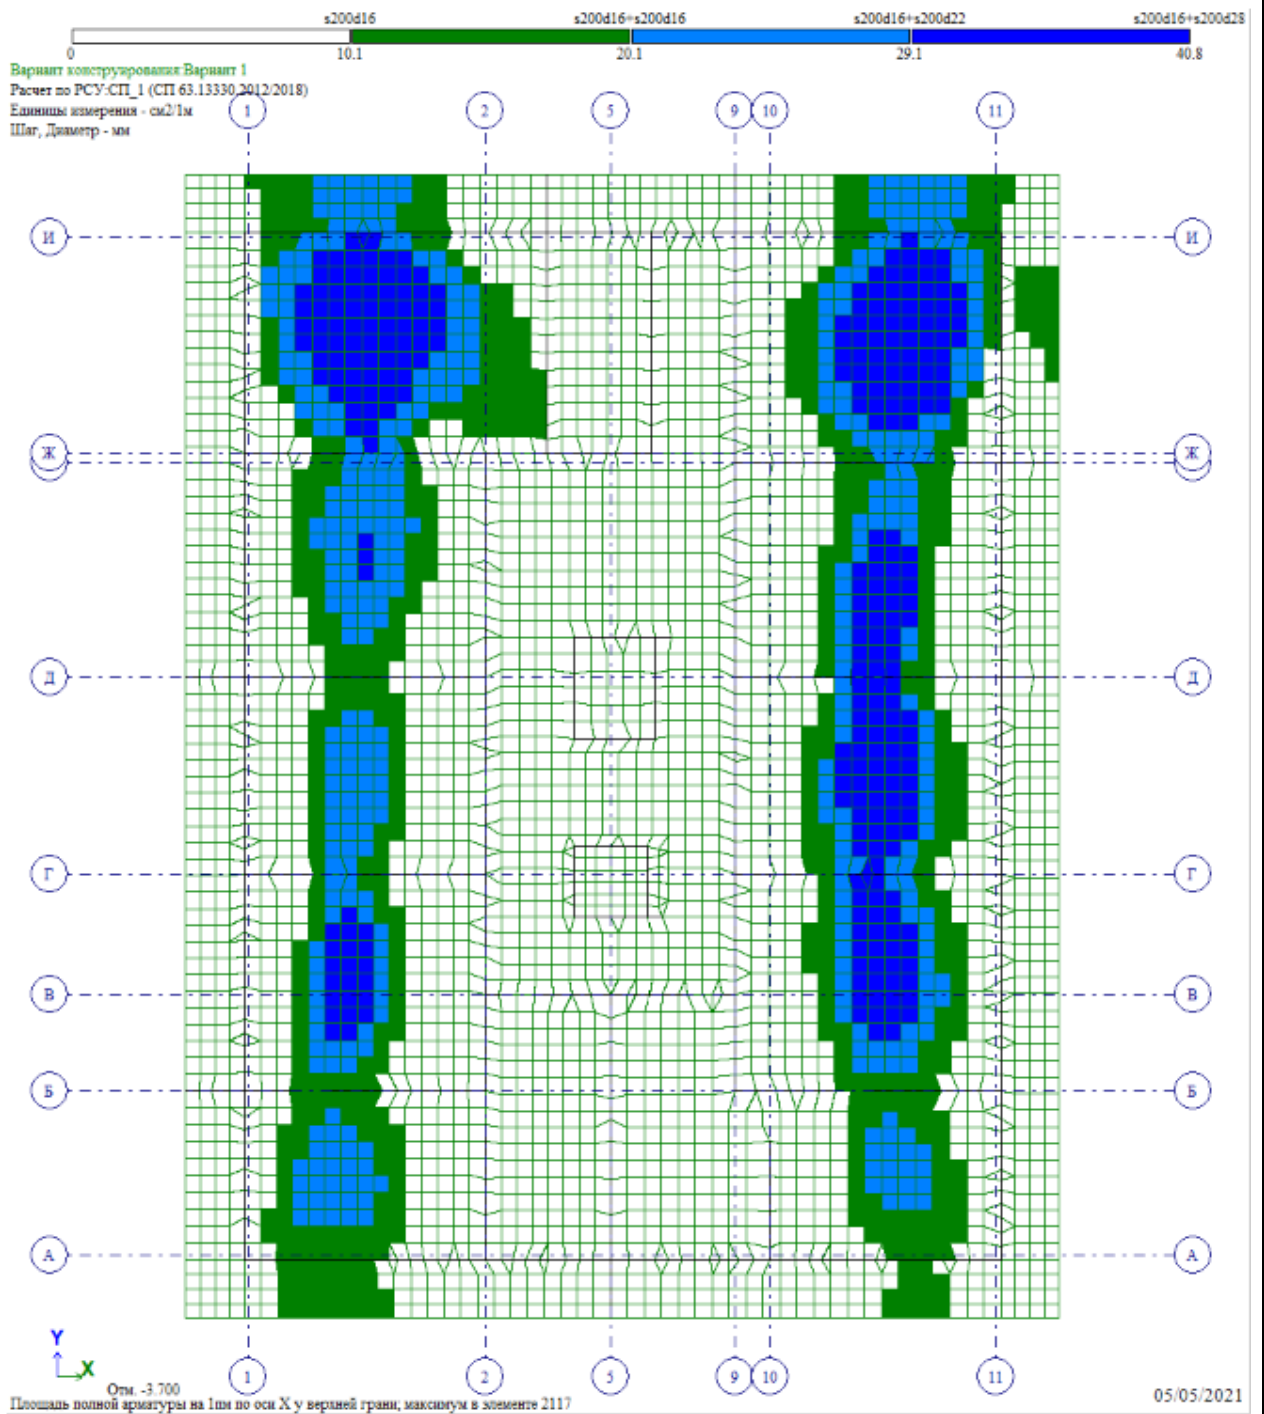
армирование верхней зоны фундаментной плиты по оси X
